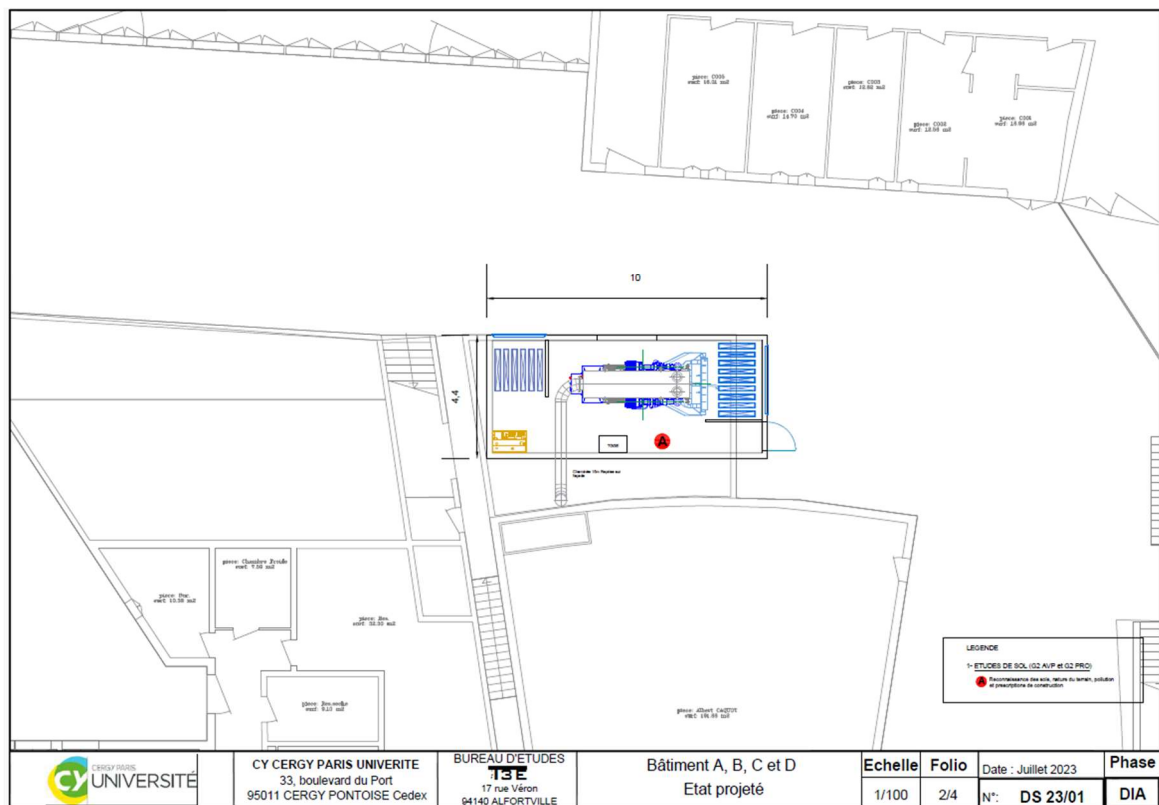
Plan bâtiment A, B, C et D – état projeté
